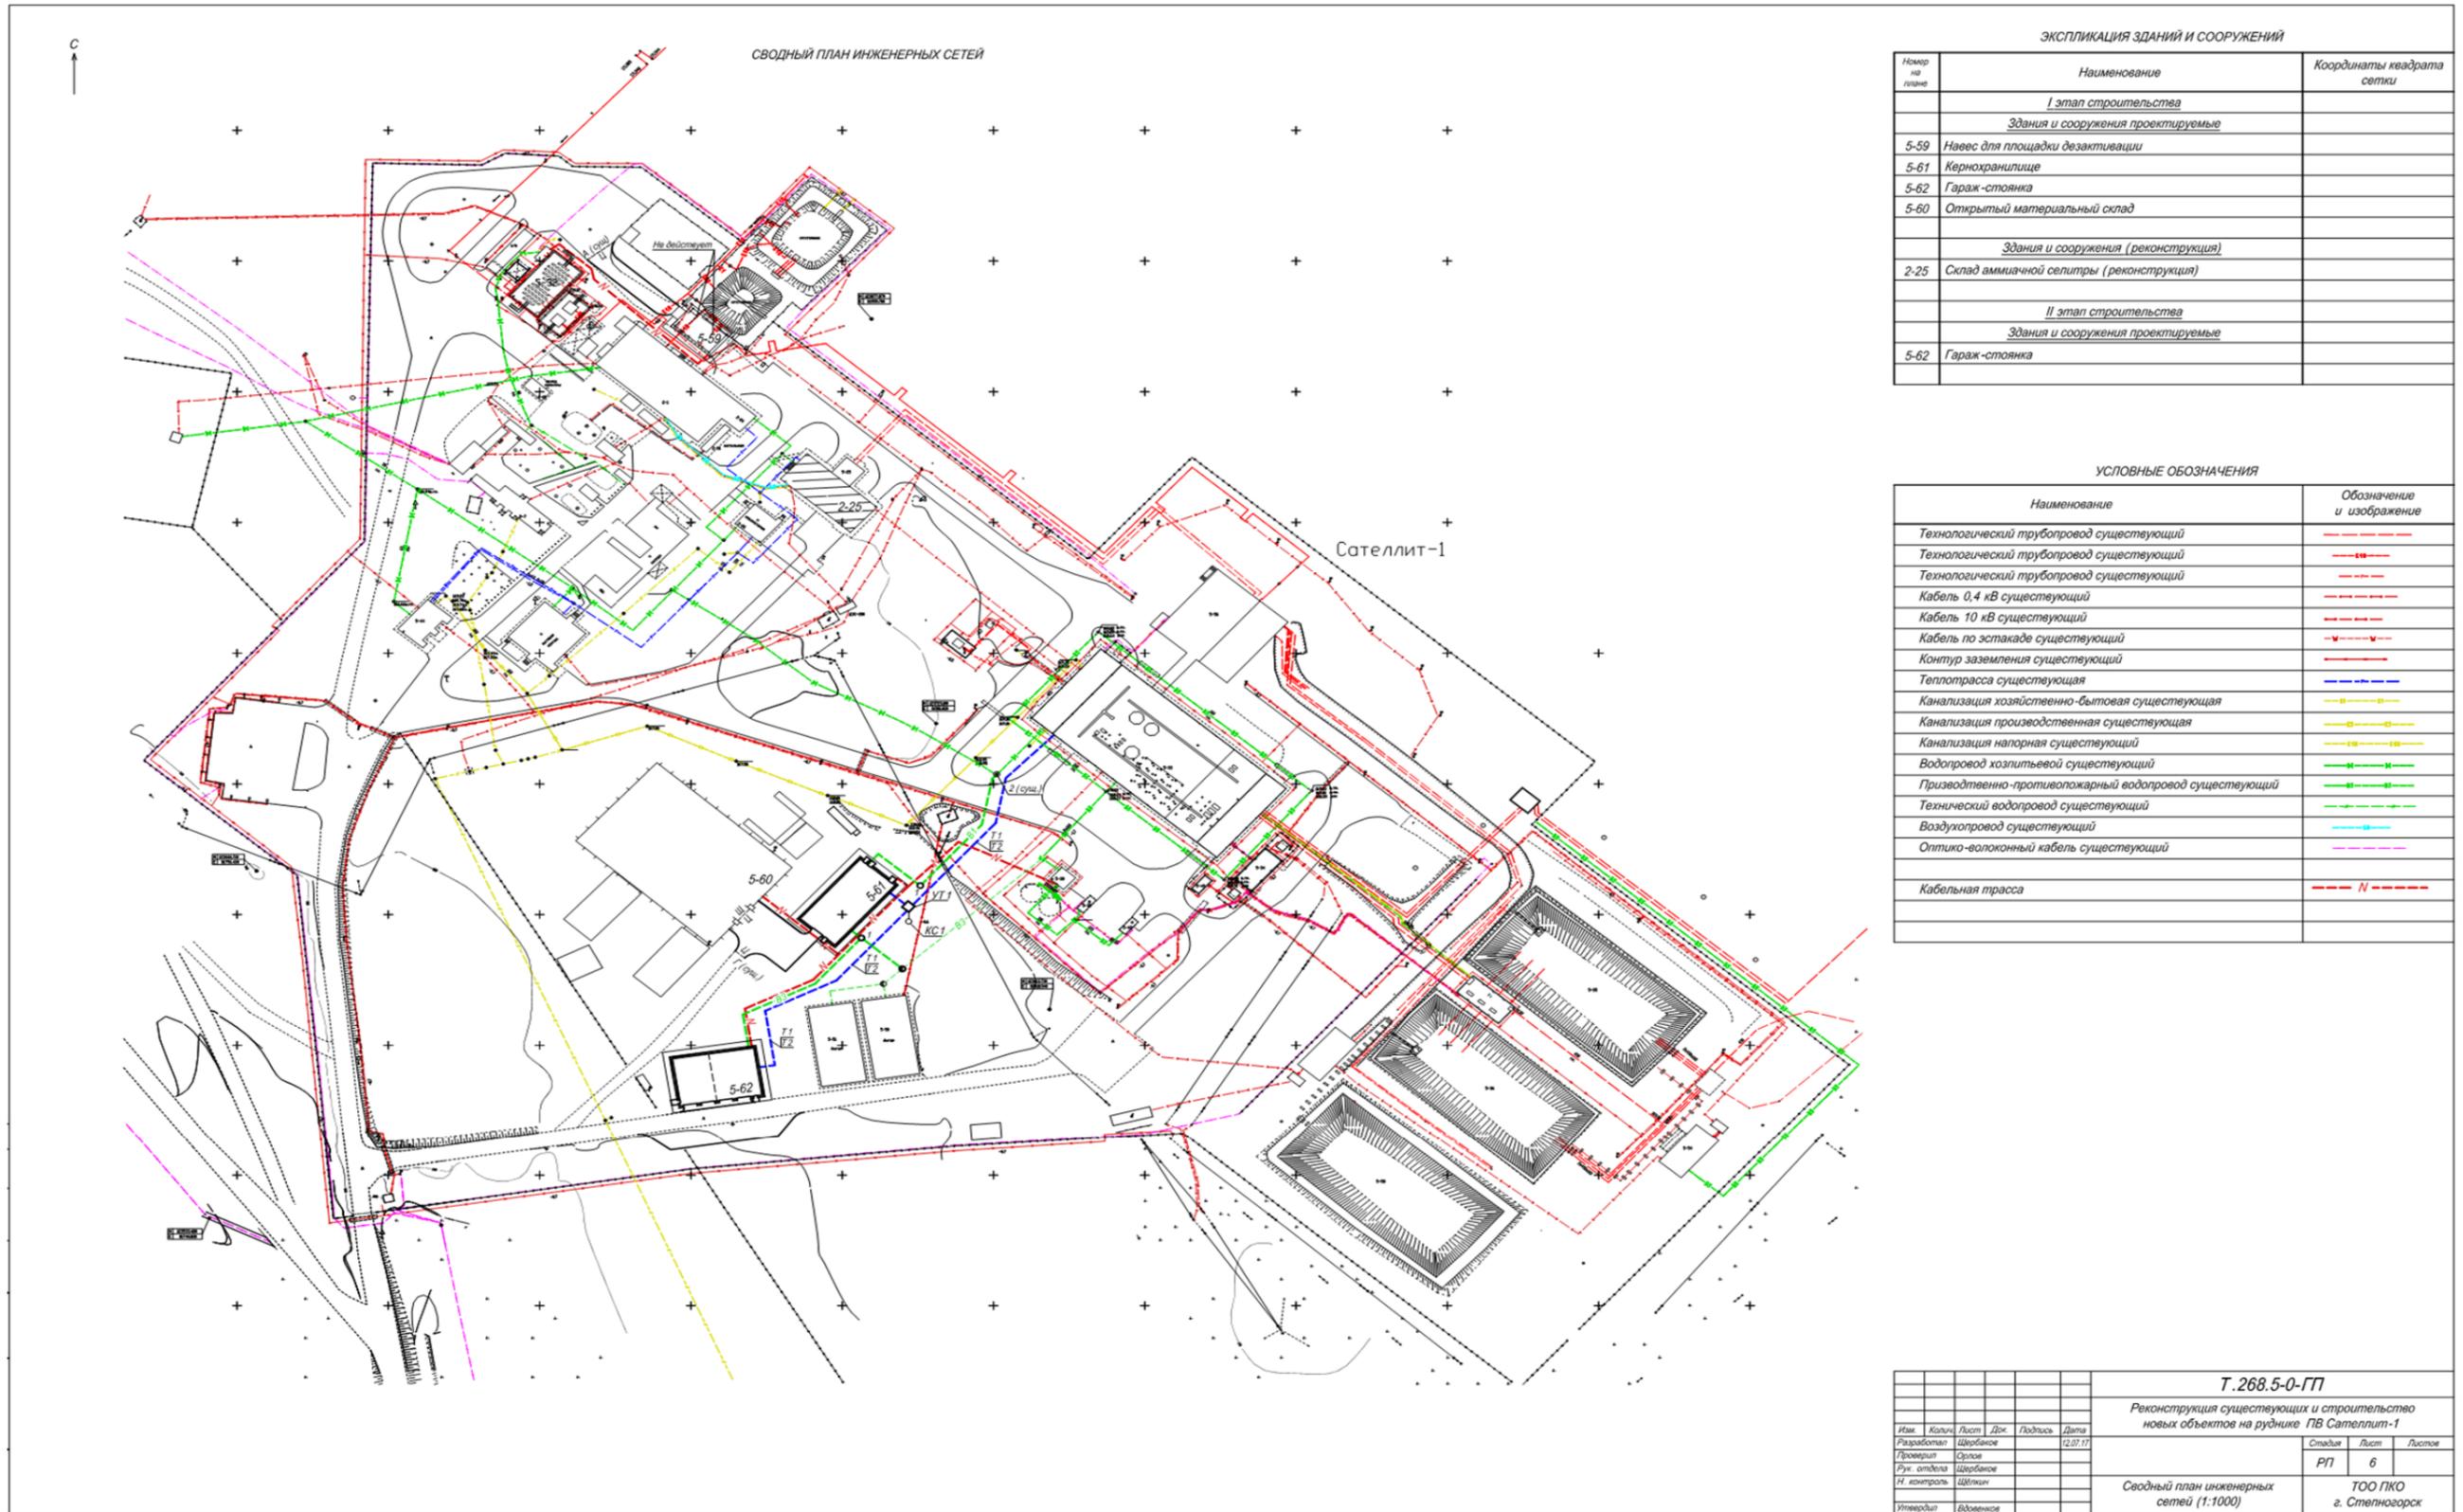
План расположения зданий и сооружений промплощадки Сателлит-1
